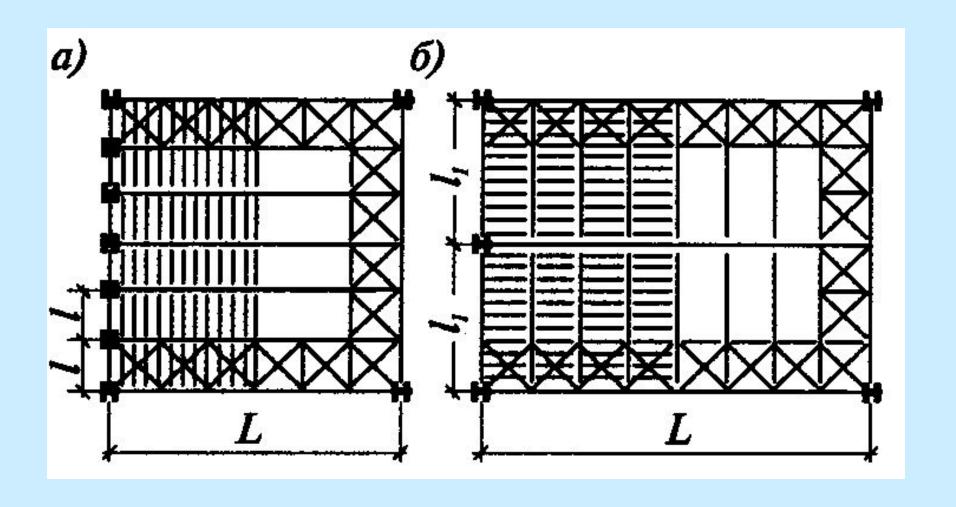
Схемы балочных покрытий: а) традиционная; б) усложненная
